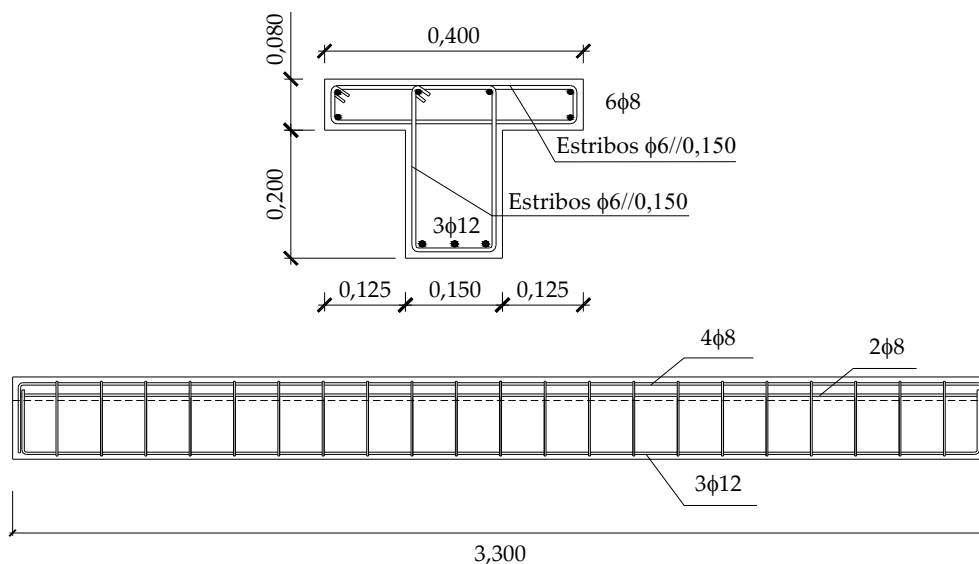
Pormenorização das armaduras das vigas de secção transversal em T (unidades em metros).
